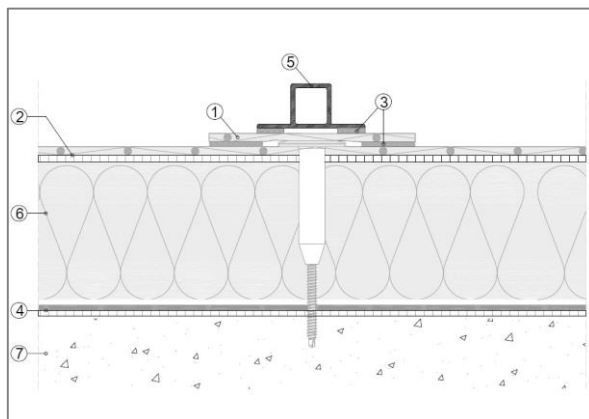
RENOLIT ALKORPLAN SOLAR Profil poleg preklopa strešnih membran
